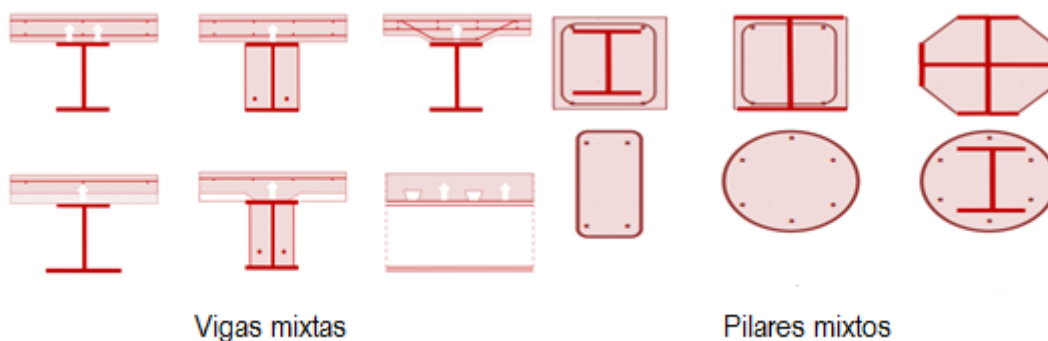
Secciones transversales vigas y pilares mixtos [3].
